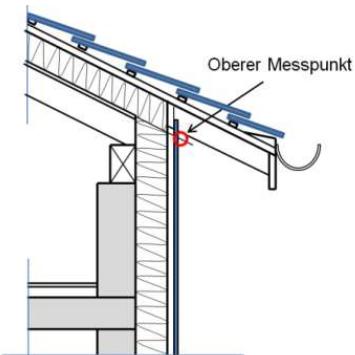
Schema oberer Messpunkt Fassadenhöhe
